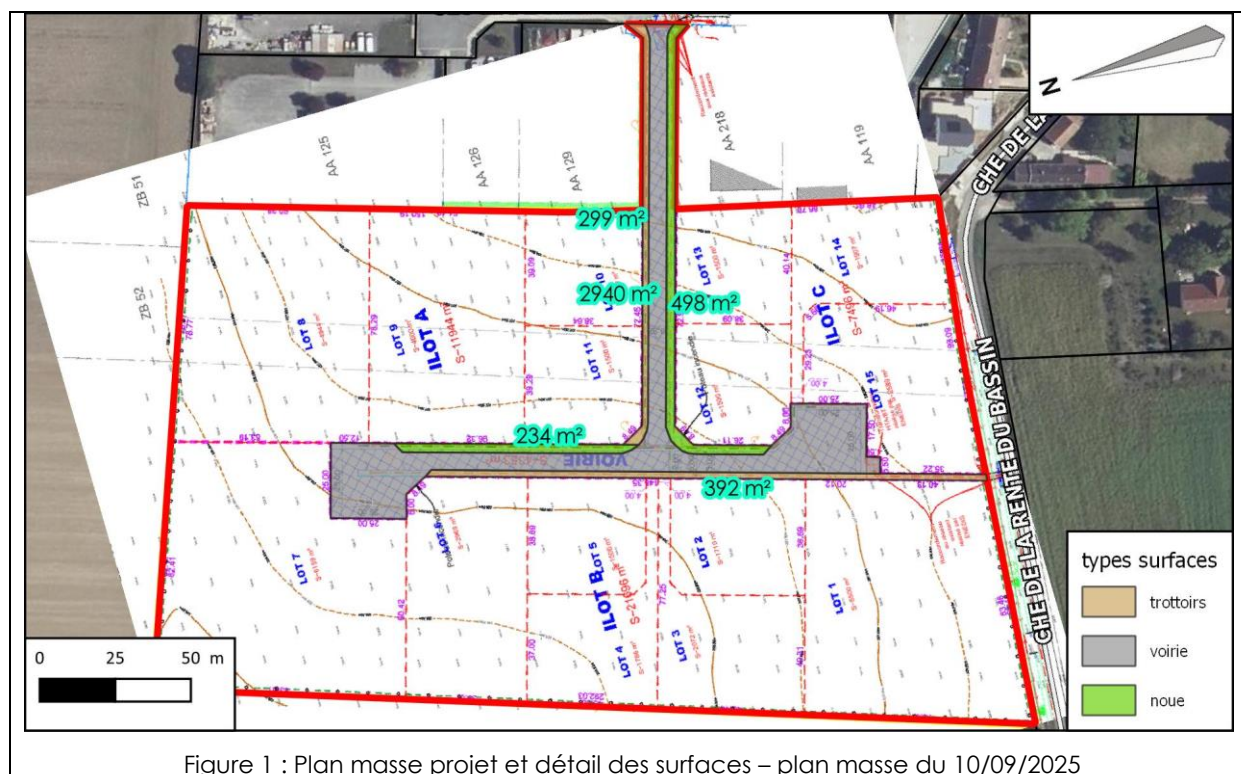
Plan masse projet et détail des surfaces – plan masse du 10/09/2025
